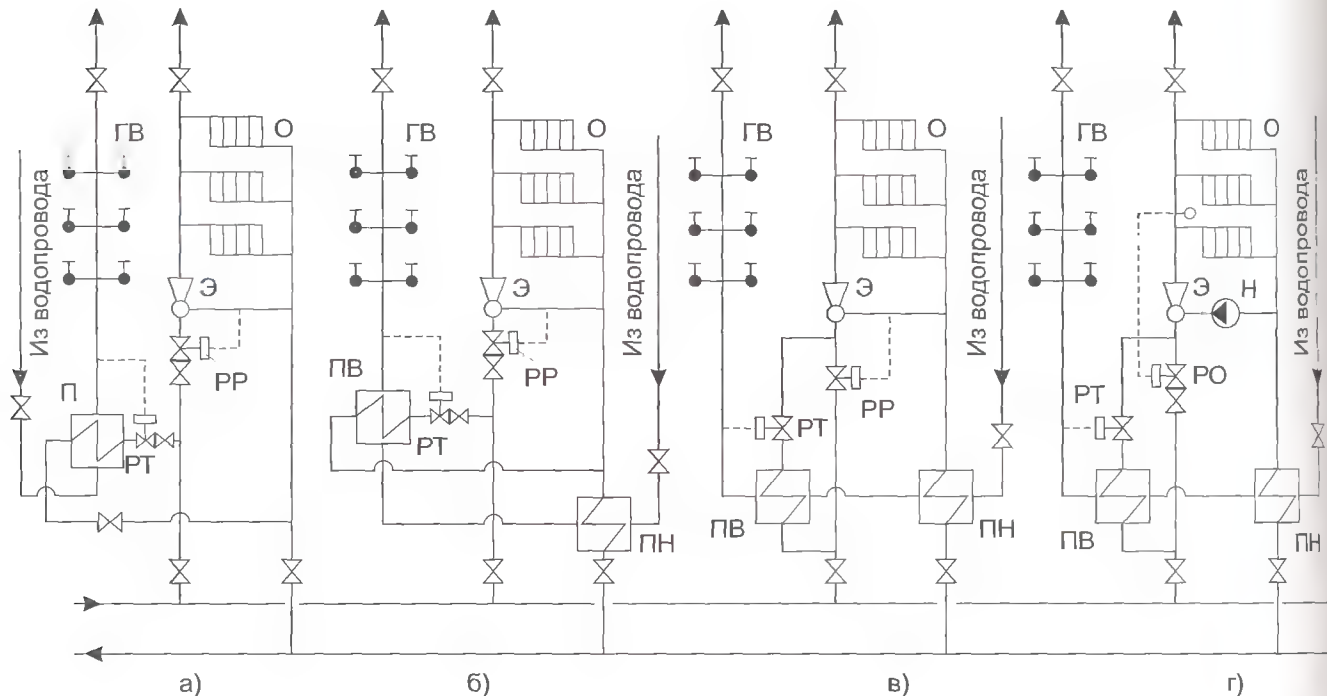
Схемы совместного присоединения систем отопления и горячего водоснабжения к закрытой тепловой сети:
